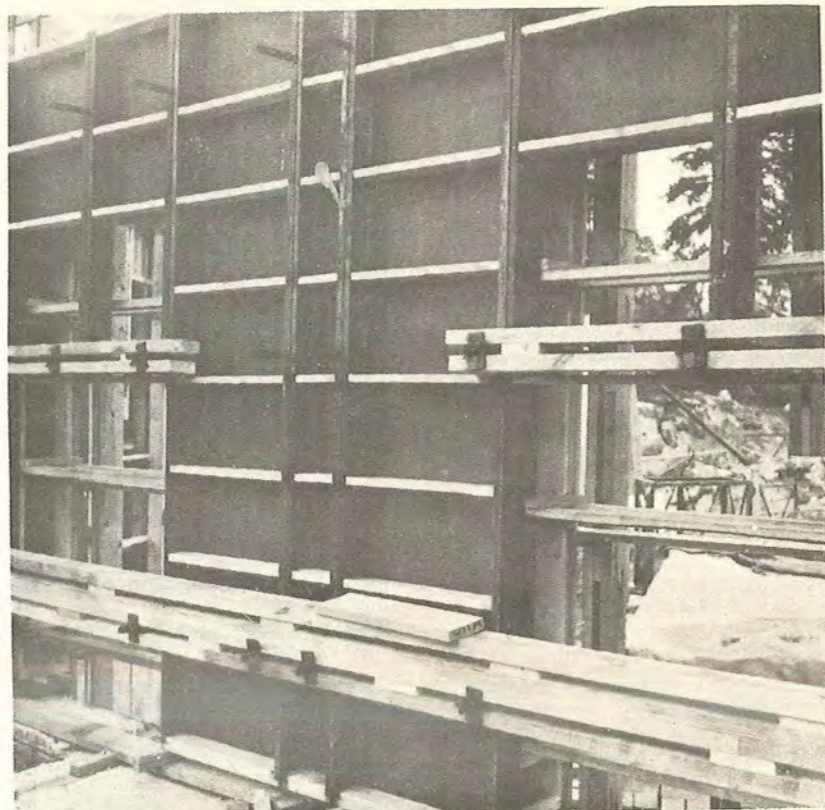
Kassetter med pladejernsramme (SVEMA) med vandrette strøer af træ og 12,5 mm påsømmet formplade.
